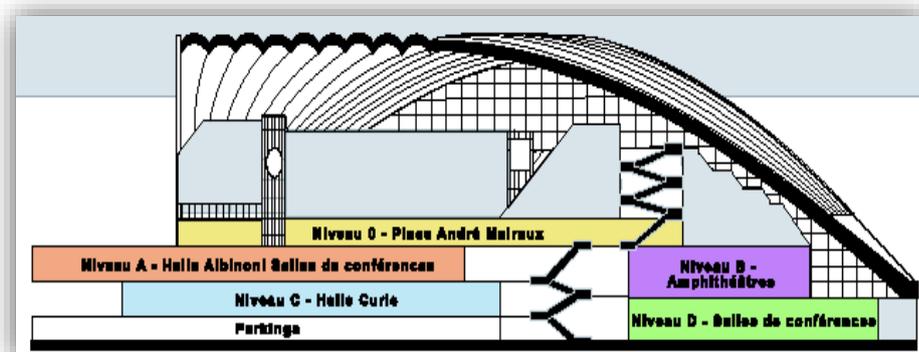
coupe qui montre la disposition des étage (source : auteur)
